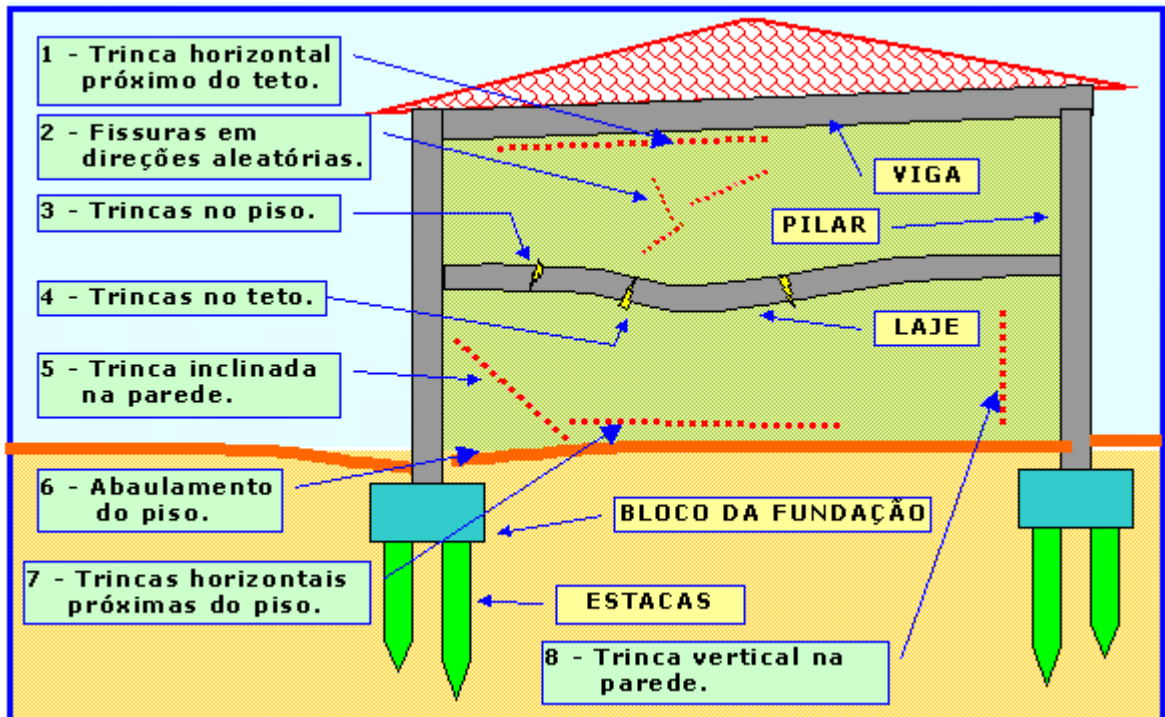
Ilustração de alguns tipos de trincas e fissuras e suas causas em edificações.
